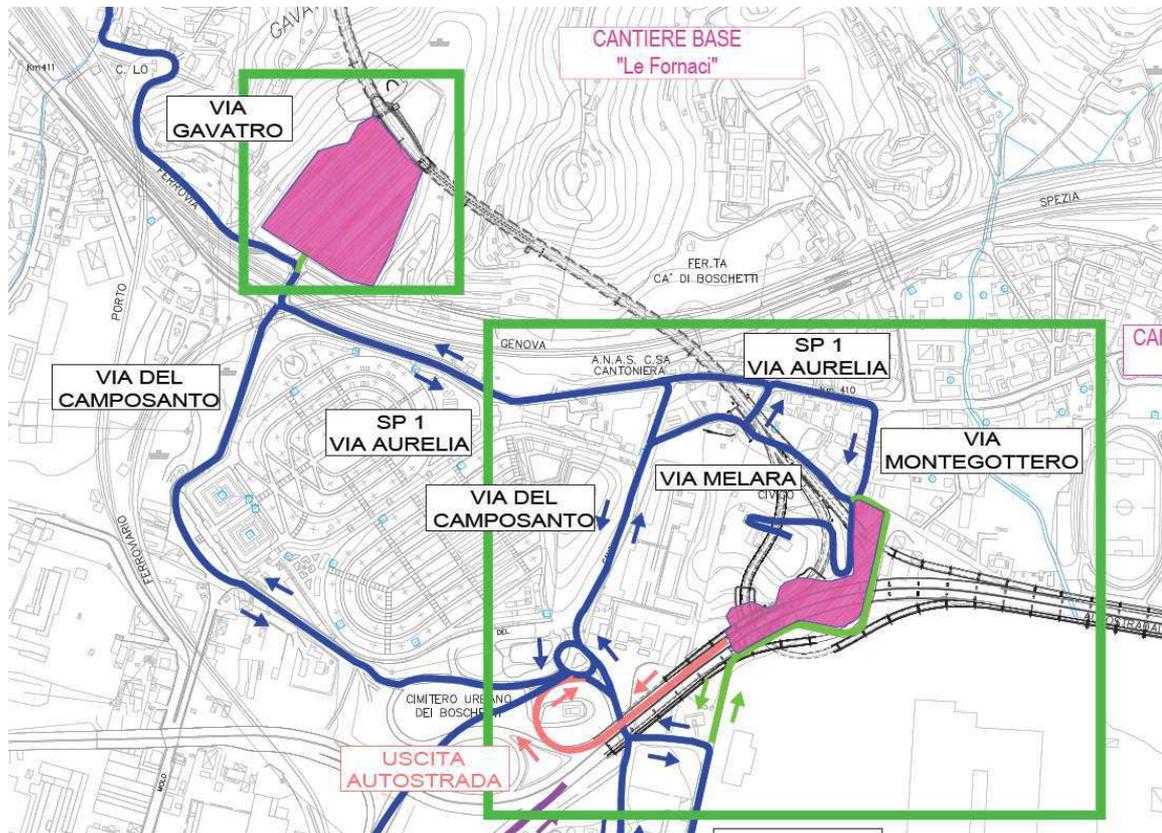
Planimetria con indicazione delle aree di cantiere
